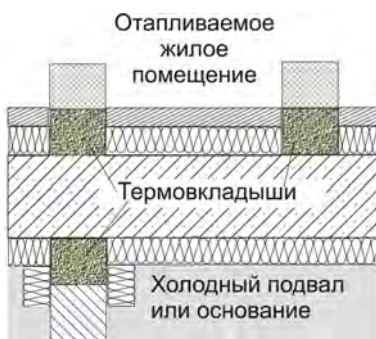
«Тепловые мостики» в месте стыка внутренних стен с фундаментными стенами и подвальным перекрытием
